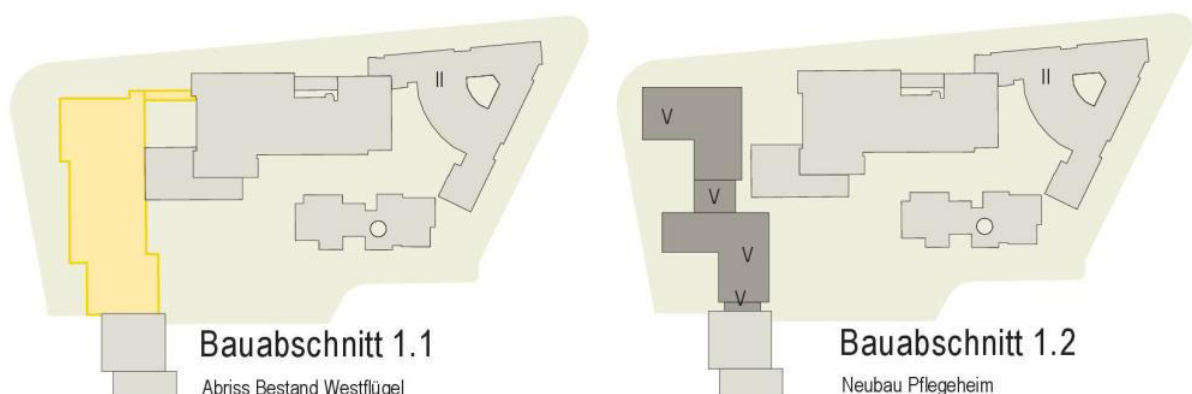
Bauabschnitt 1.1 (Abriss Westflügel) /1.2 (Neubau Pflegeheim)
